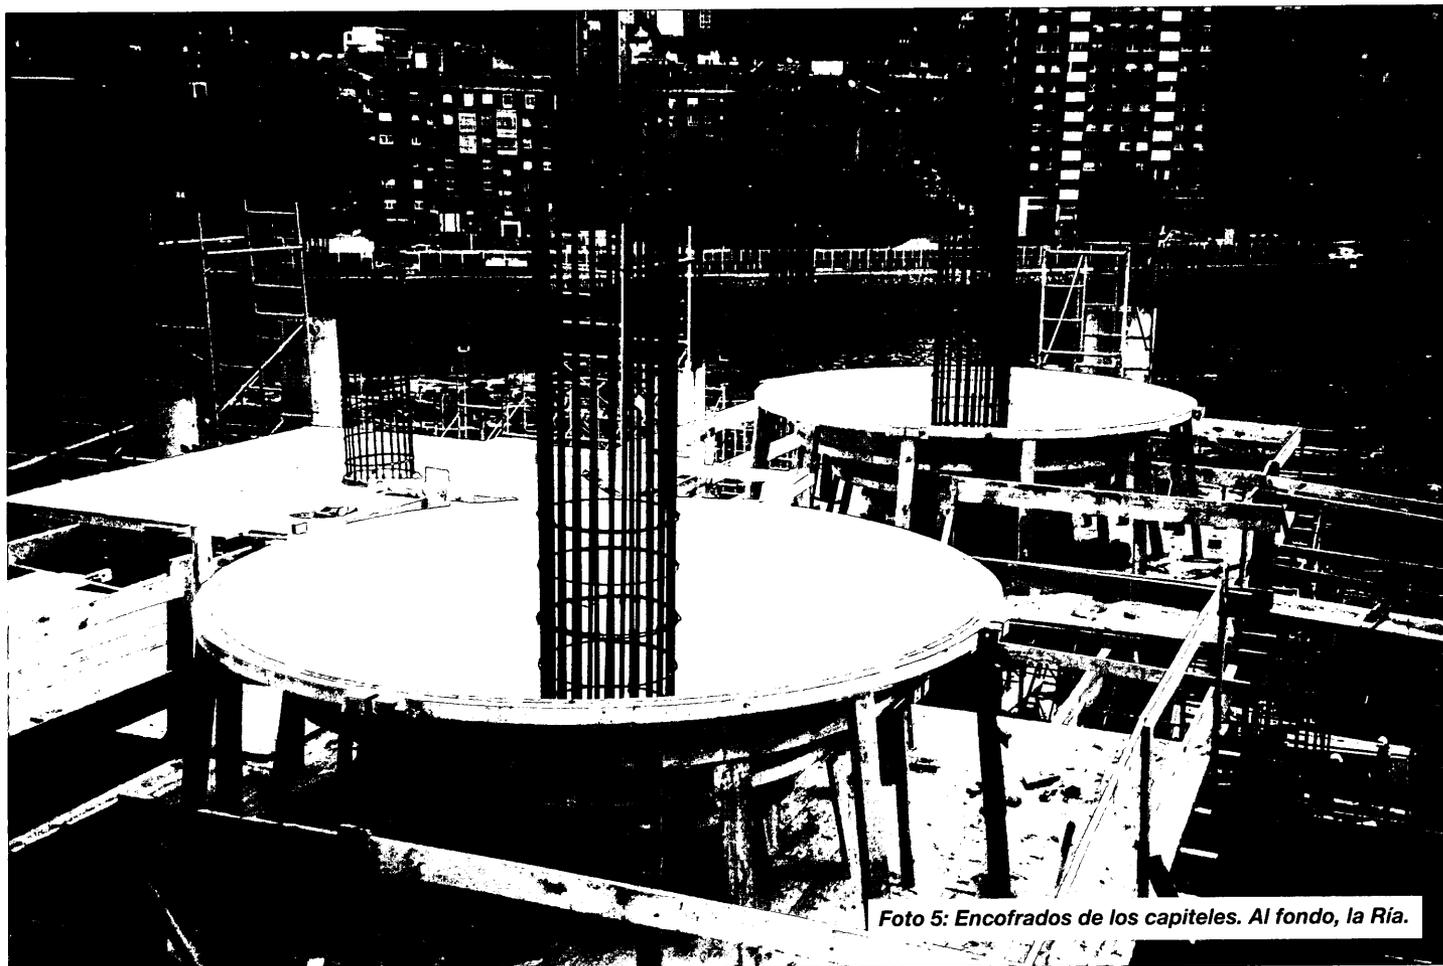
Encofrados de los capiteles. Al fondo, la Ría.
